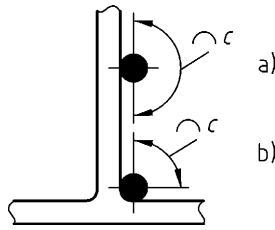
Wirksamer Umfang c eines Bewehrungsstabes
